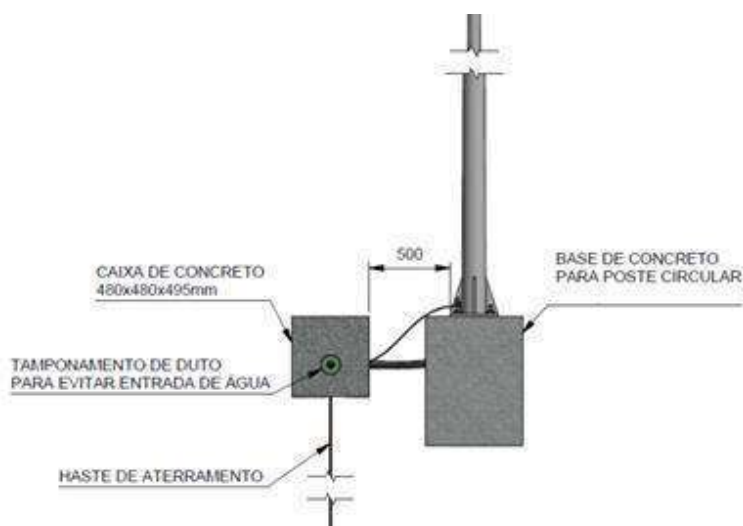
Detalhamento do poste de iluminação pública metálico a ser utilizado
